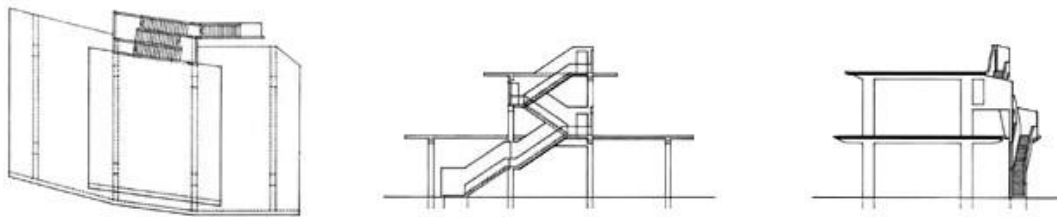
Proyecto Ökohaus (1989-91), Berlin. Planta y alzados del soporte tipo de hormigón armado, 1987
